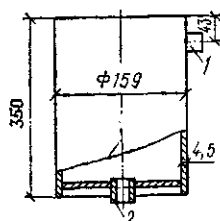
Вертикальный непроточный воздухоотборник ВС-3
